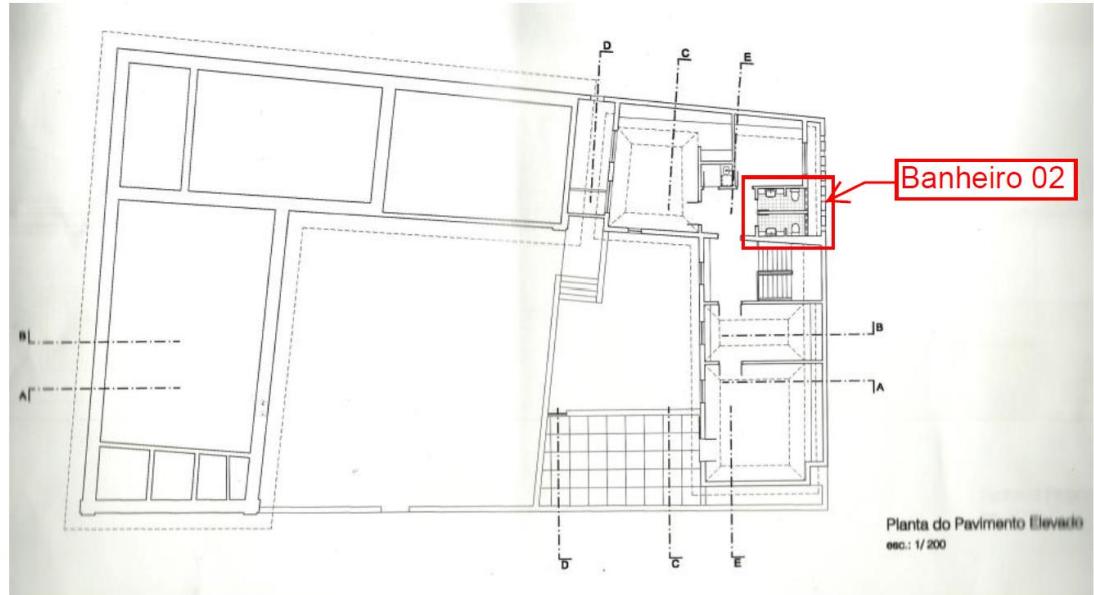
Planta Anexo II – Localização Banheiro 02 - Segundo Piso
